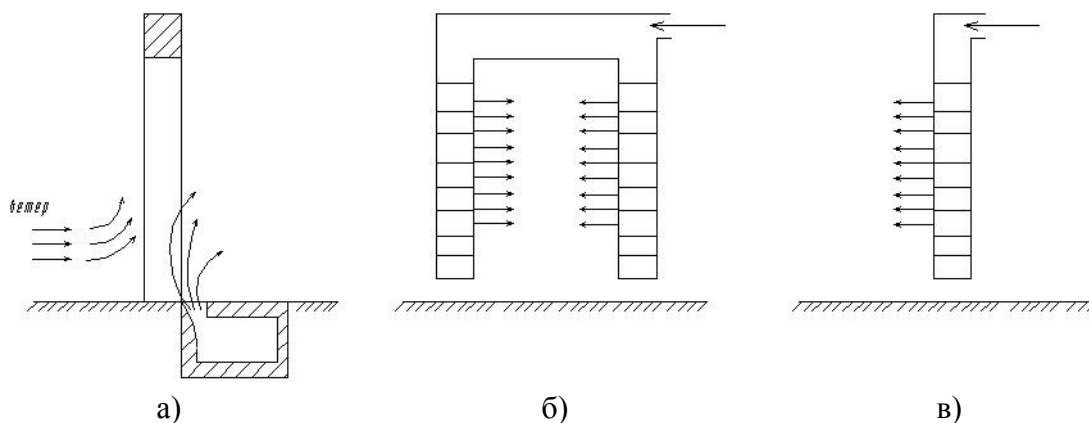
Воздушные и воздушно-тепловые завесы: а - нижние;
